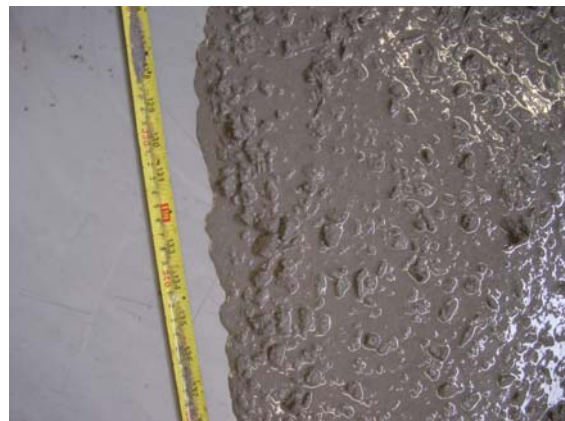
Pormenor da fronteira do círculo de betão espalhado.
